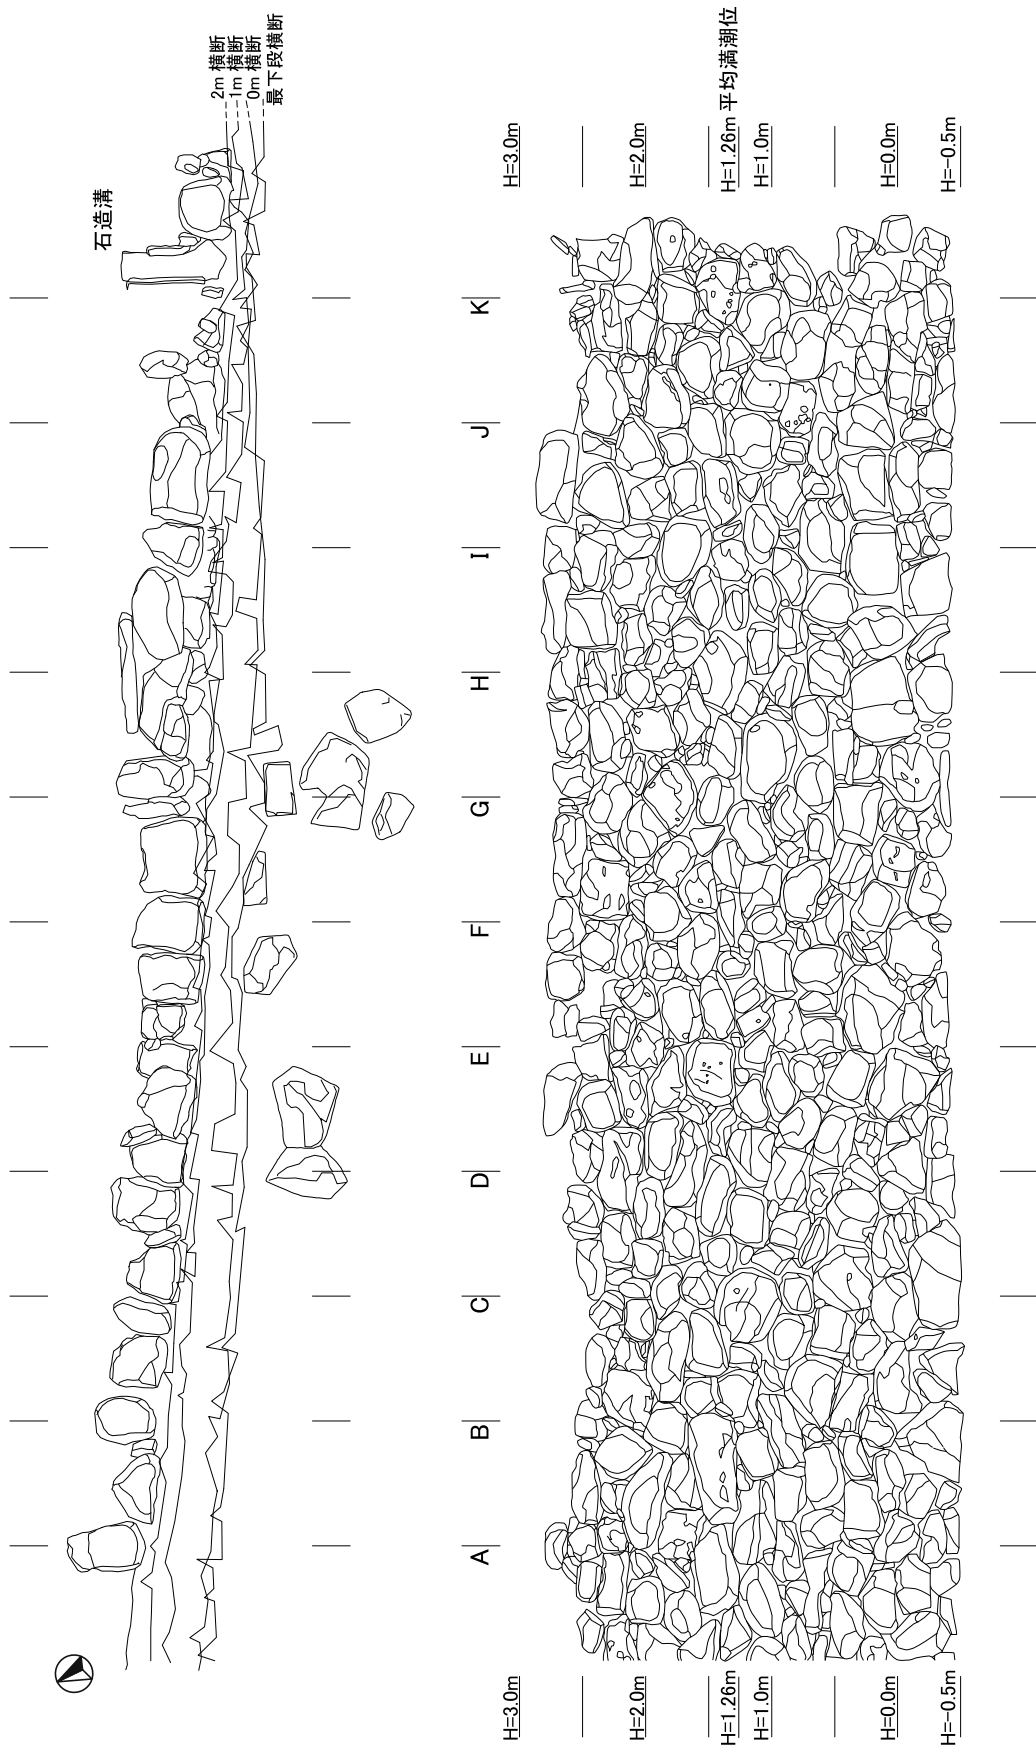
①-1 南側護岸石垣 平面図・立面図 (S=1/60)
